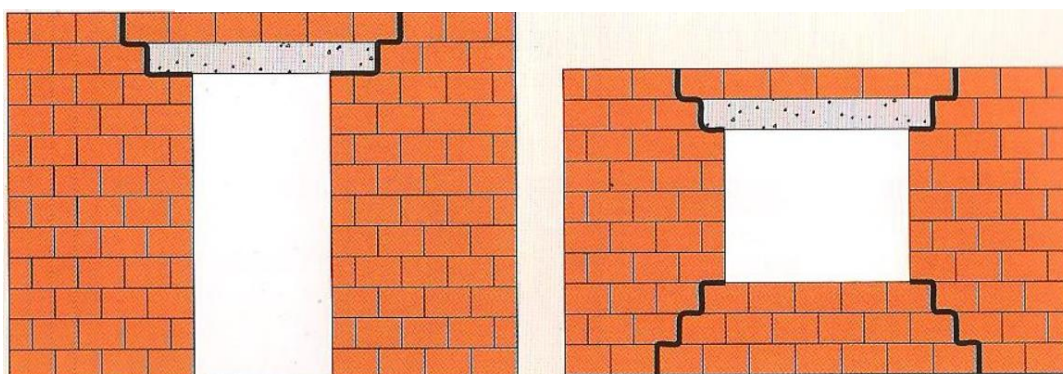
Fissuração típica em zona de vão [64]
